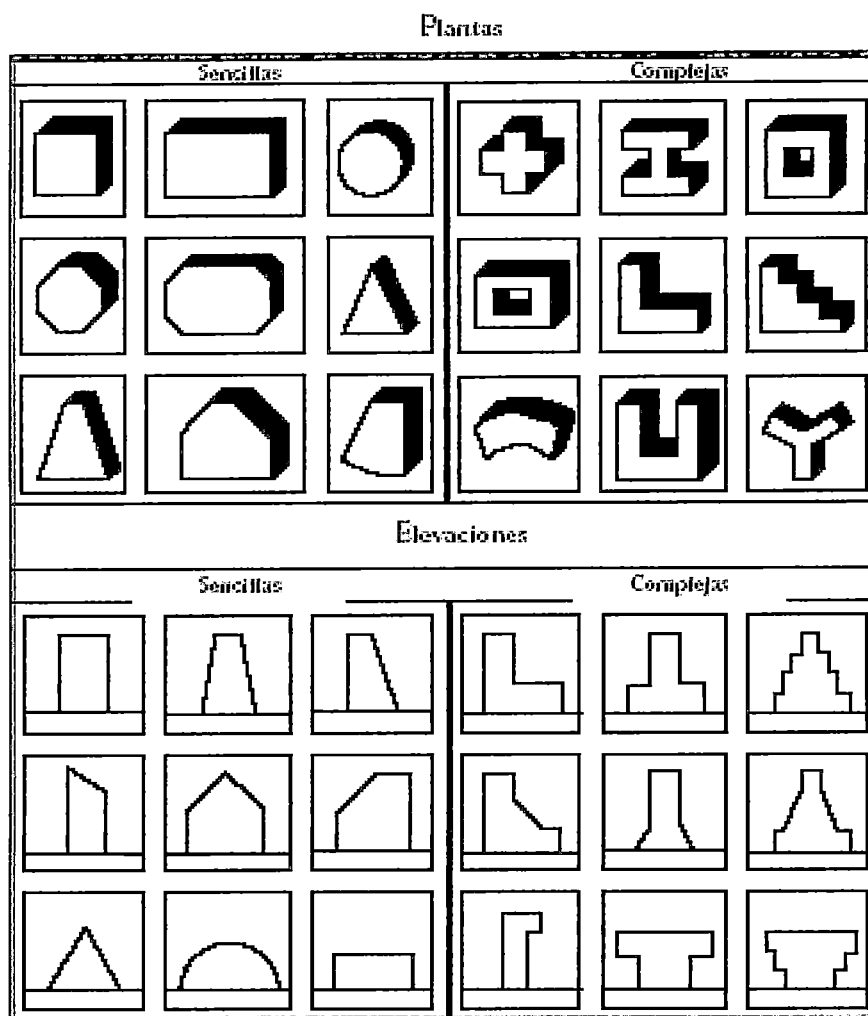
Formas sencillas y complejas en planta y elevación
